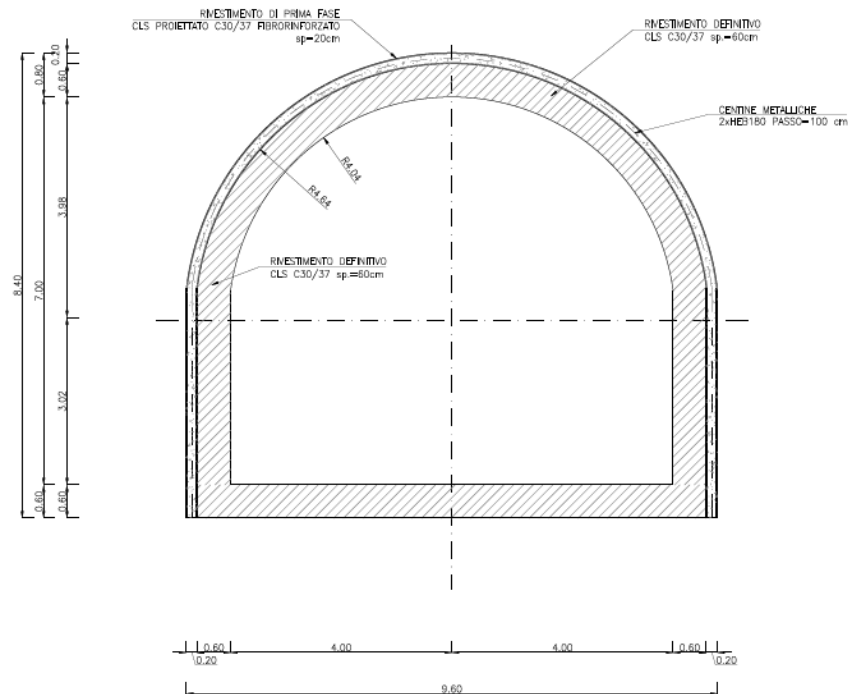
Sezione tipo P-Piez 2: geometria del cavo e interventi di sostegno
